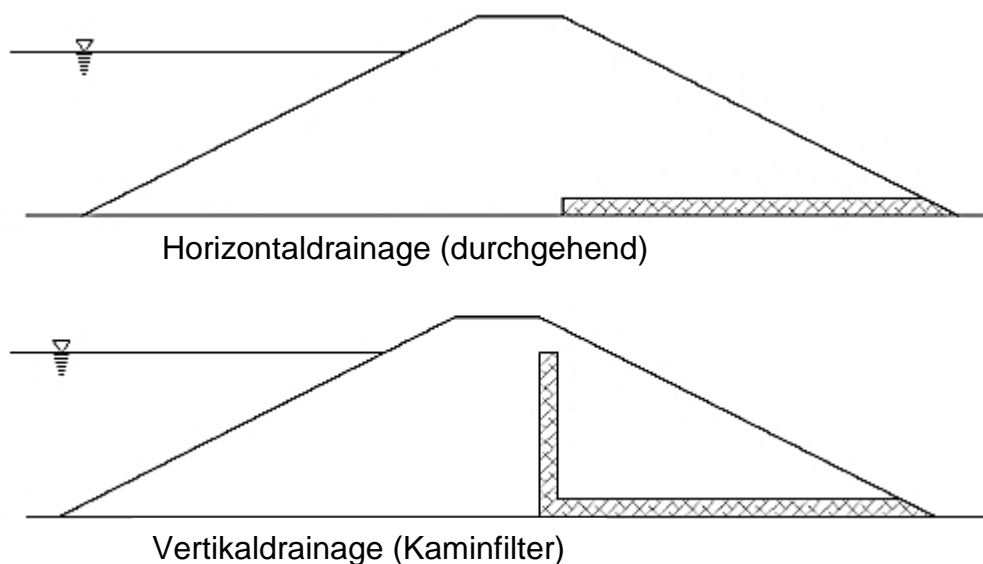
Homogendamm mit Horizontaldrainage (oben), mit Vertikaldrainage (unten)
